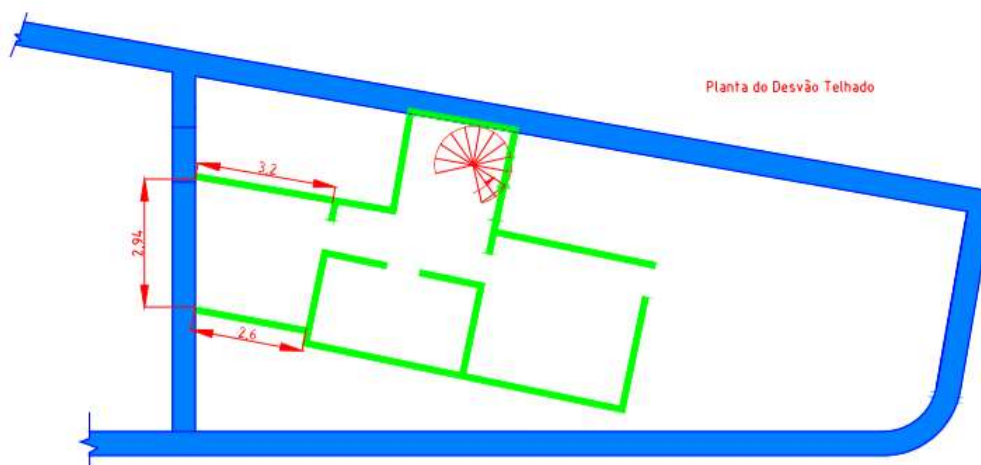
Planta Arquitetura atualizada do Sótão
